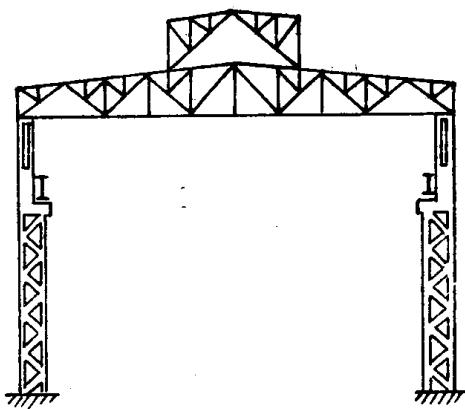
钢屋架与钢筋混凝土柱组成的排架结构
